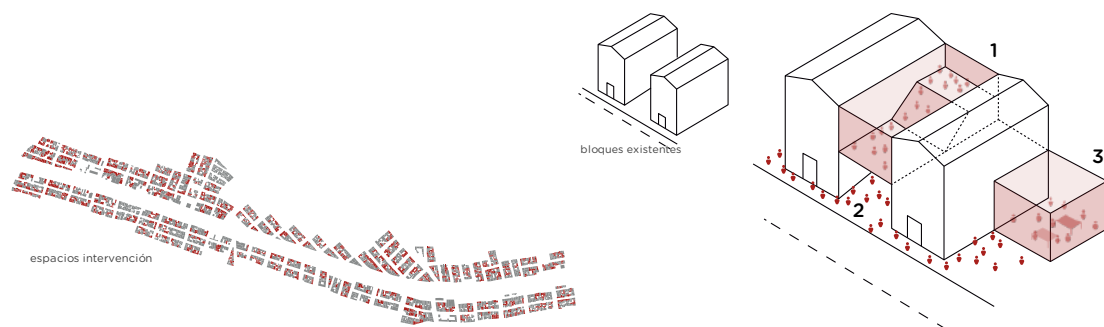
Estrategias Arquitectónicas | Conexiones Híbridas
